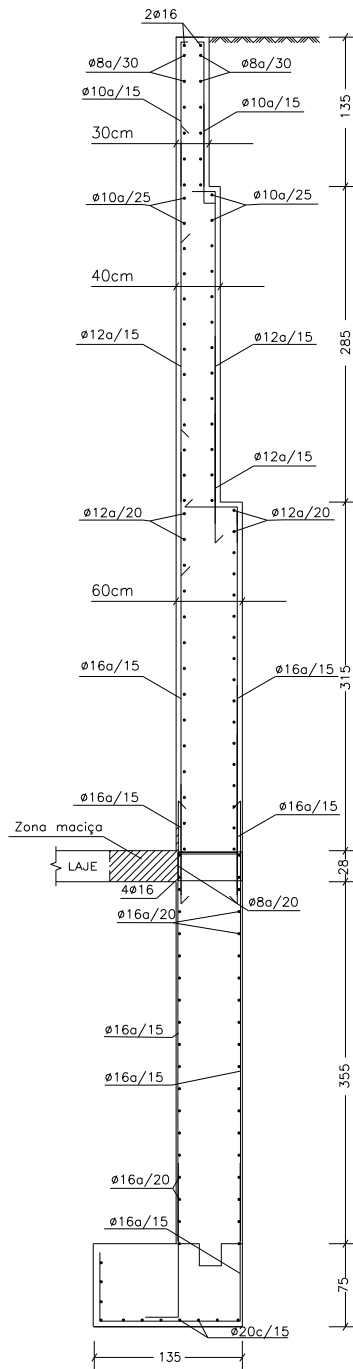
Pormenor de armaduras do muro de contenção M1, (sem escala)
